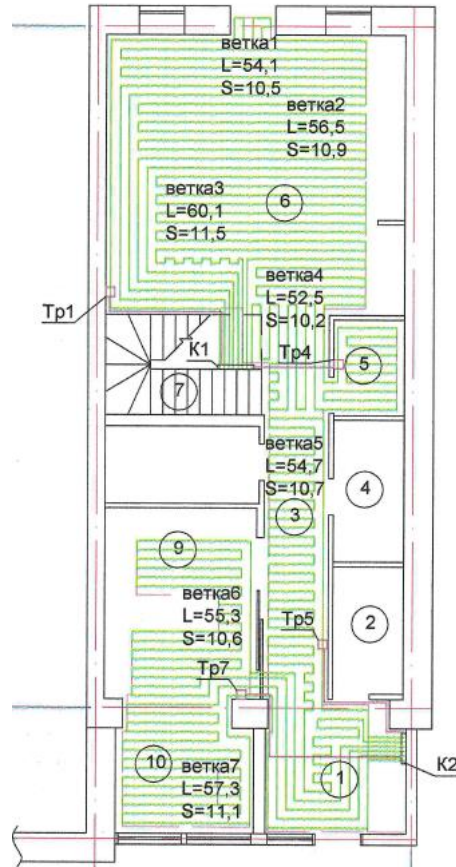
схема размещения теплого пола на первом этаже дома.
